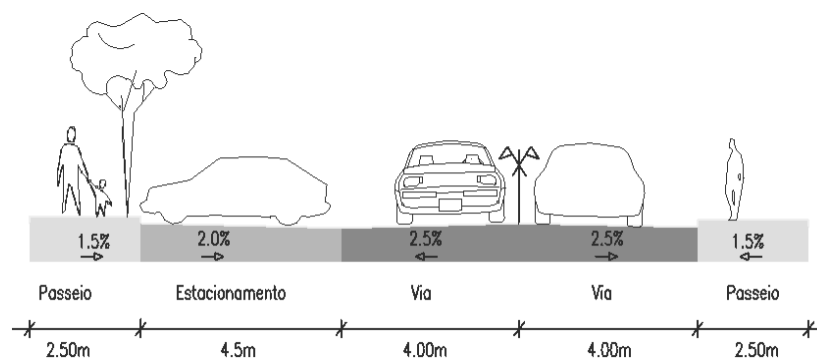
Perfil Transversal Tipo 4 – Eixos 6
